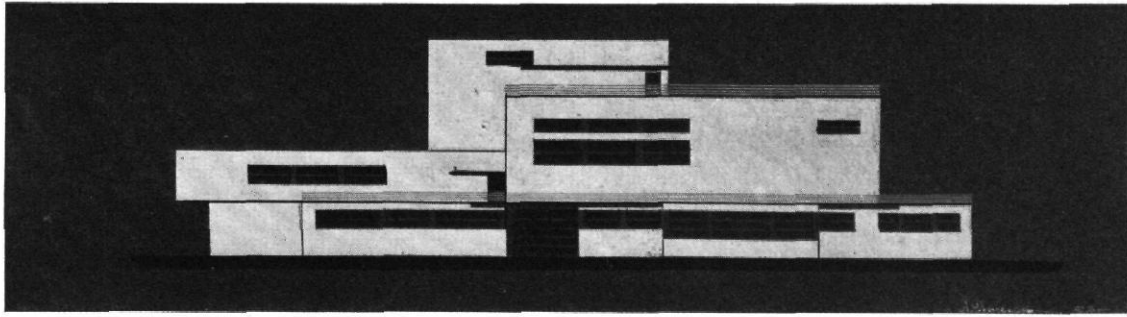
bis 5 | Entwurf zu einem Arbeiterklub | Architekt: K. Malewitsch | Grundrisse: L. Kidenell
